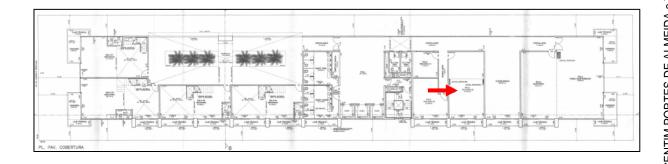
Laje de cobertura do sétimo pavimento.
